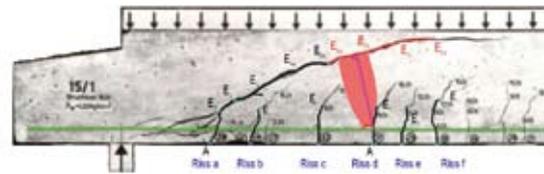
Ausschnittsvergrößerung des Balkens 15/1 aus [3] mit Kennzeichnung der Rissabschnitte A - E5d im Zustand II.5
